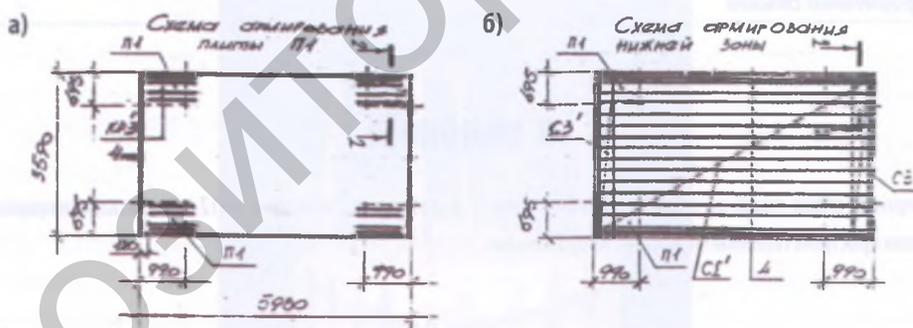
Схема армирования верхней (а) и нижней (б) зон плиты перекрытия
